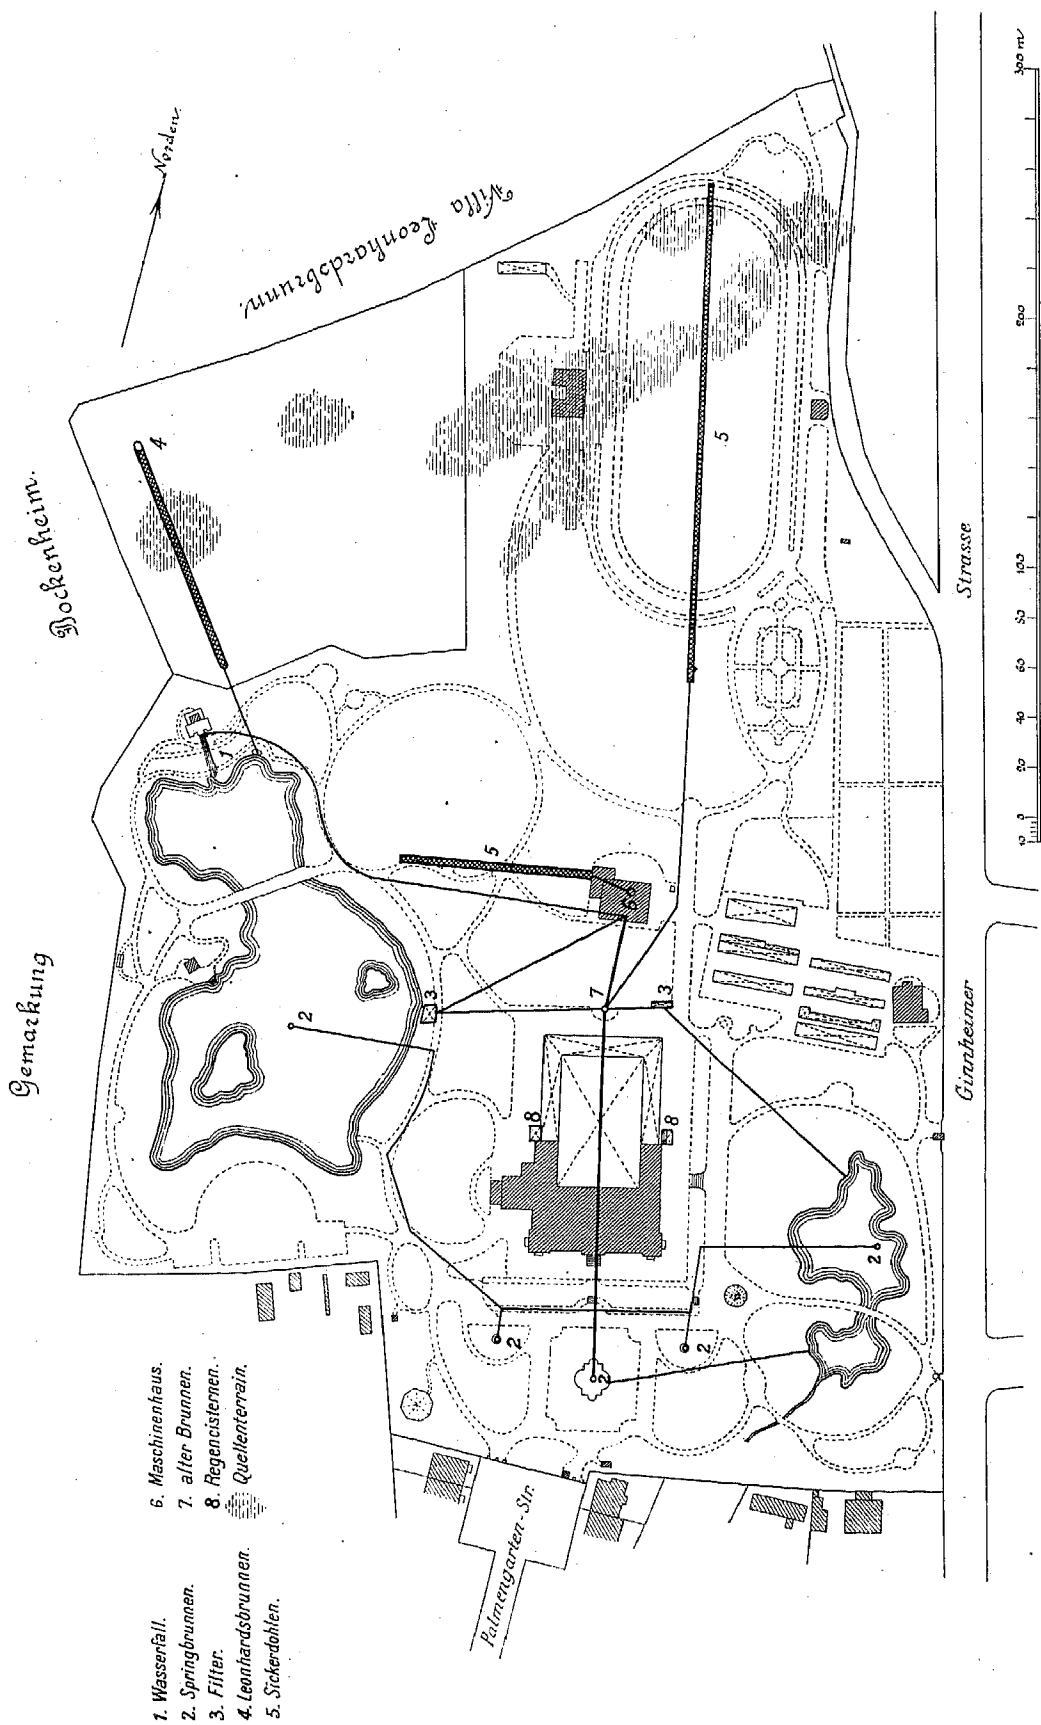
Grundplan mit den Hauptsträngen der Wasserleitung.
